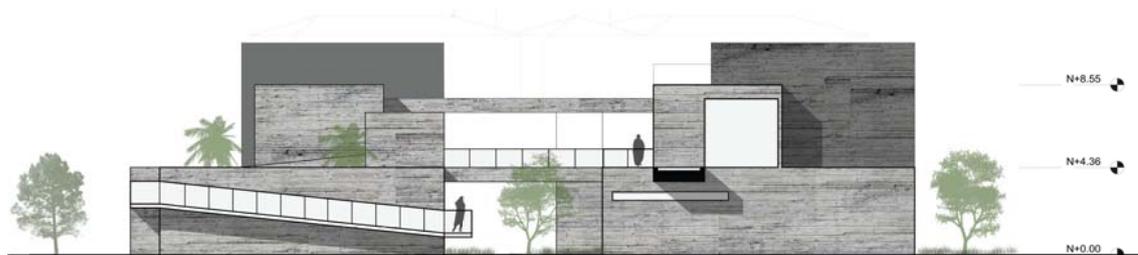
Fachada Sur. Fuente: Elaborado por el autor
